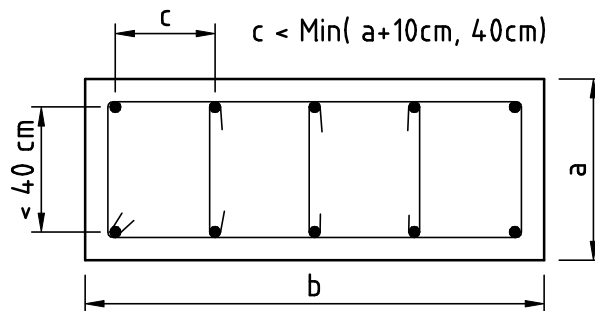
Espacement maximal des armatures longitudinales d'un poteau.
